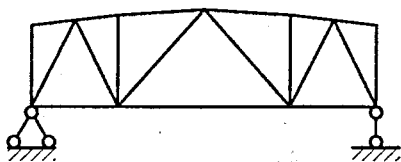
Ферма з полігональним верхнім поясом
